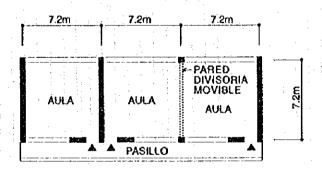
PLANTA DEL EDIFICIO TIPO 3 AULAS
